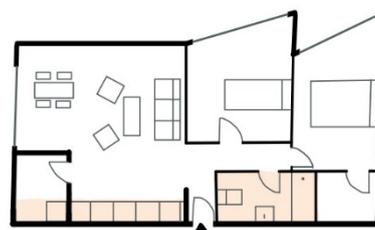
Esquema de circulación planta tipo. Elaboración propia
